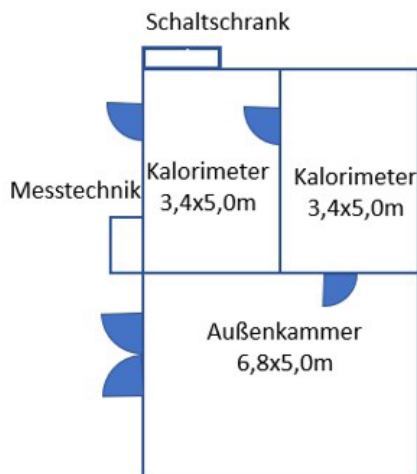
Grundriss VRF-Prüfstand mit einer Außenkammer und zwei kalorischen Innenkammern
